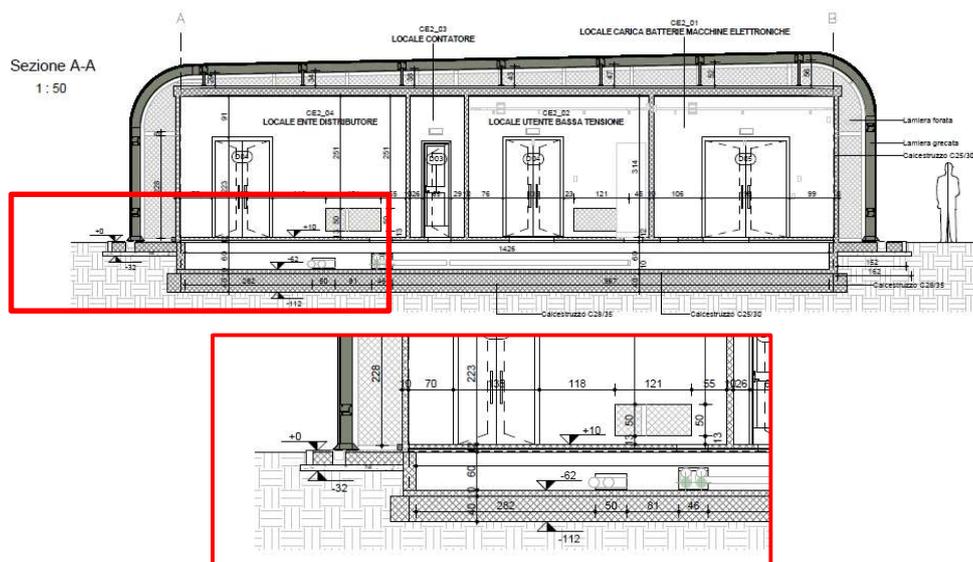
CE2 – sezione longitudinale e dettaglio fondamenta
